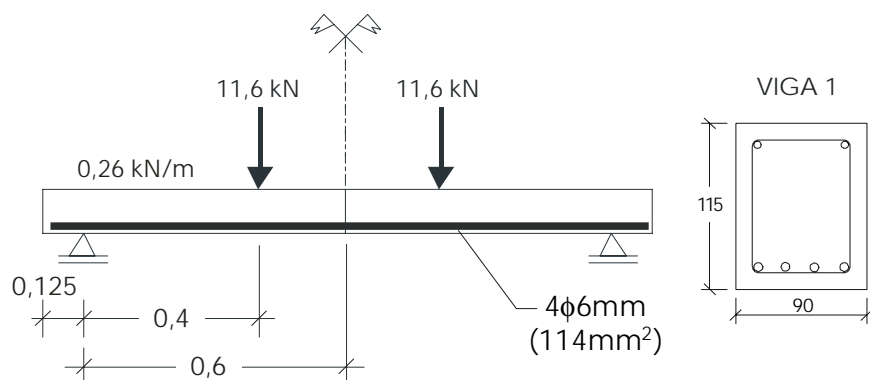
Esquema estático, dimensões e carregamento da VIGA 1
